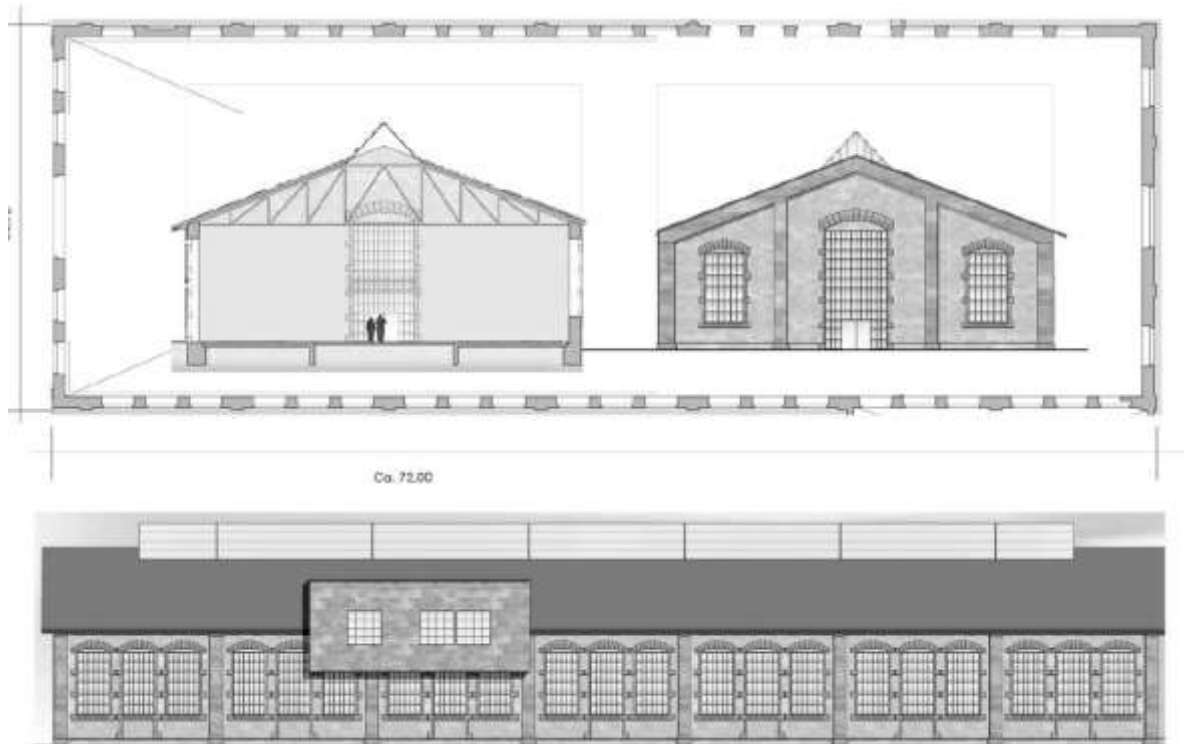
Alte Gießerei – Grundriss und Ansichten / ©Studienprojekt der FATUK 2017
